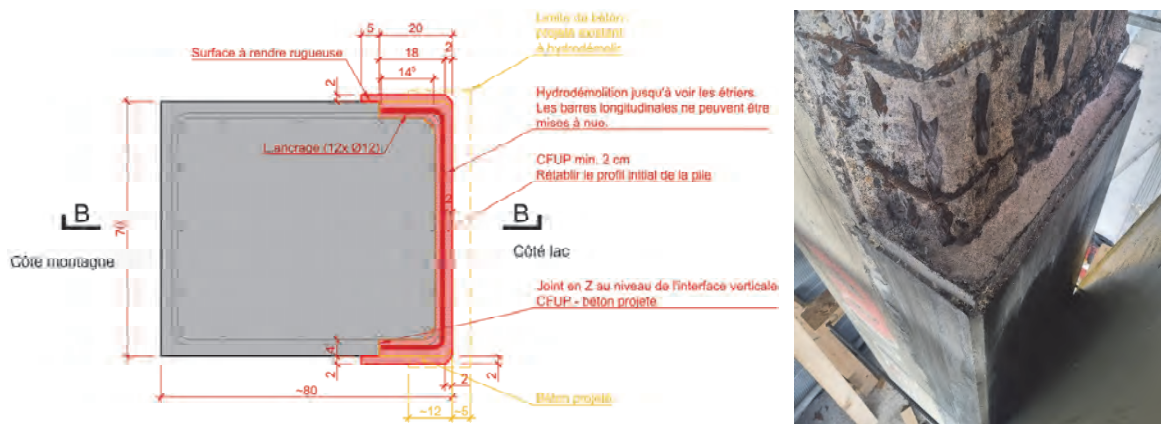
Pile - coupe type de l'intervention de "Type 1" et vue sur la pile en cours de remise en état
